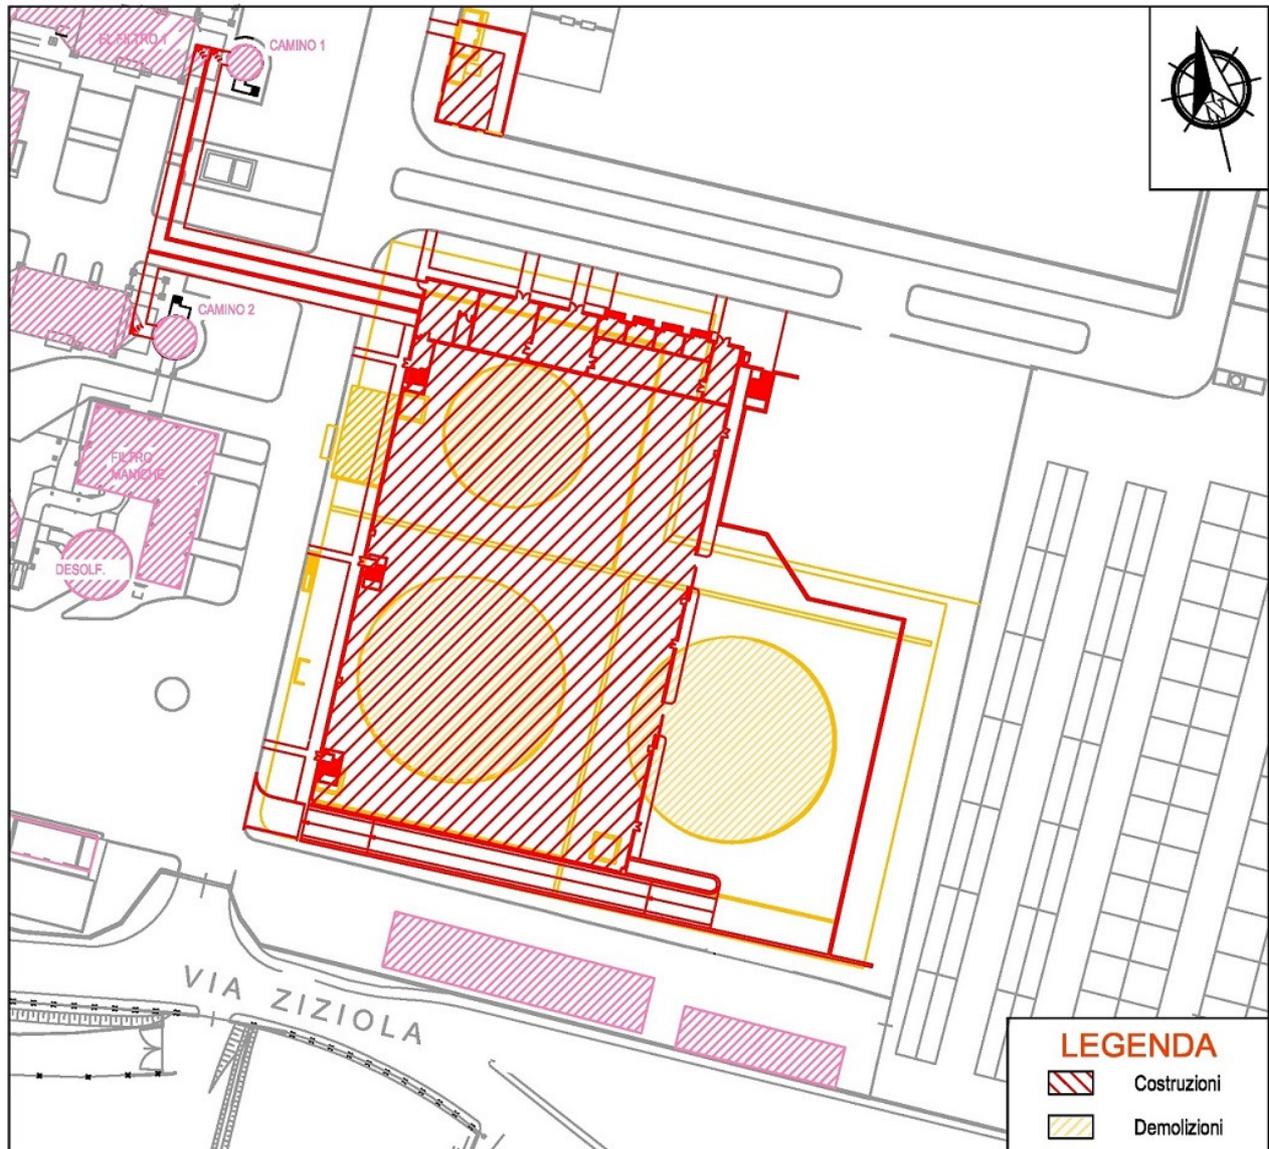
Planimetria di sovrapposizione con i serbatoi in demolizione e l'ingombro del nuovo edificio
